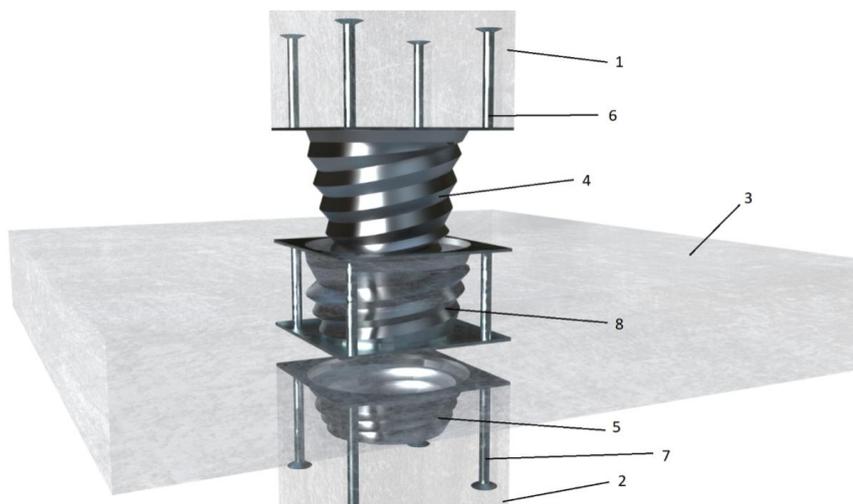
Контактное винтовое соединение сборных железобетонных колонн:
